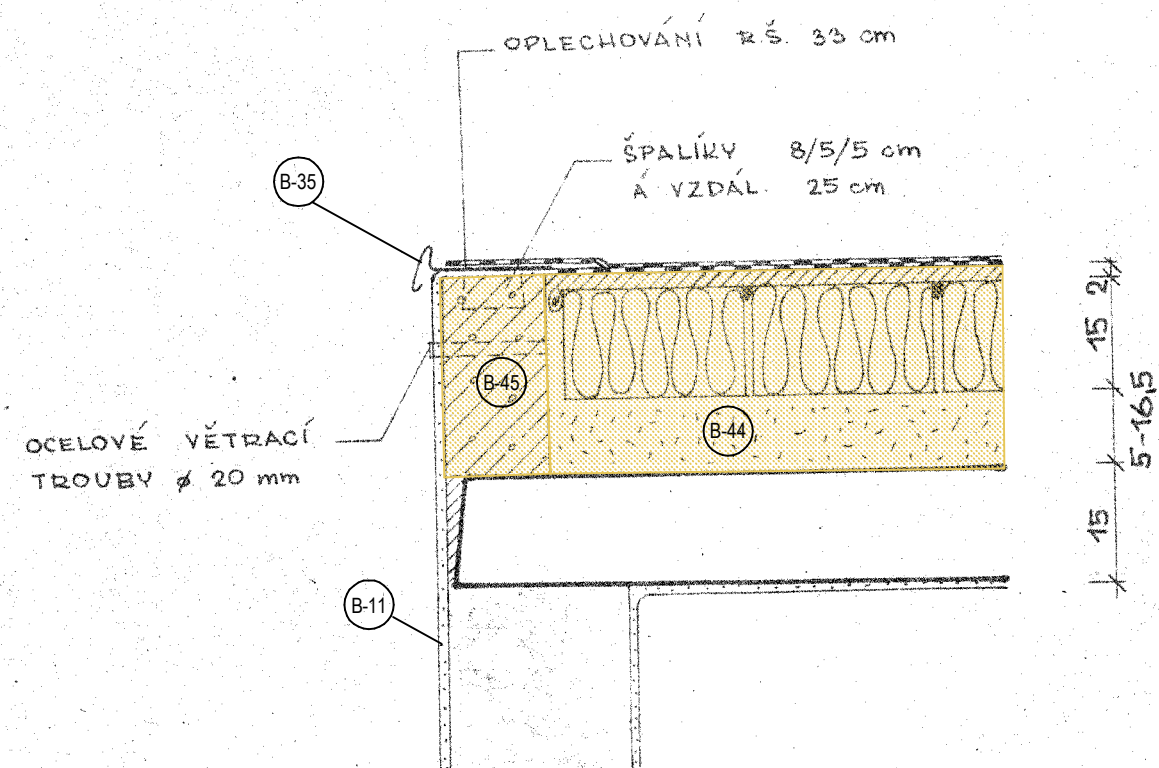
DETAIL A - ATIKA HLAVNÍ STŘEŠNÍ ROVINY - STÁVAJÍCÍ STAV
